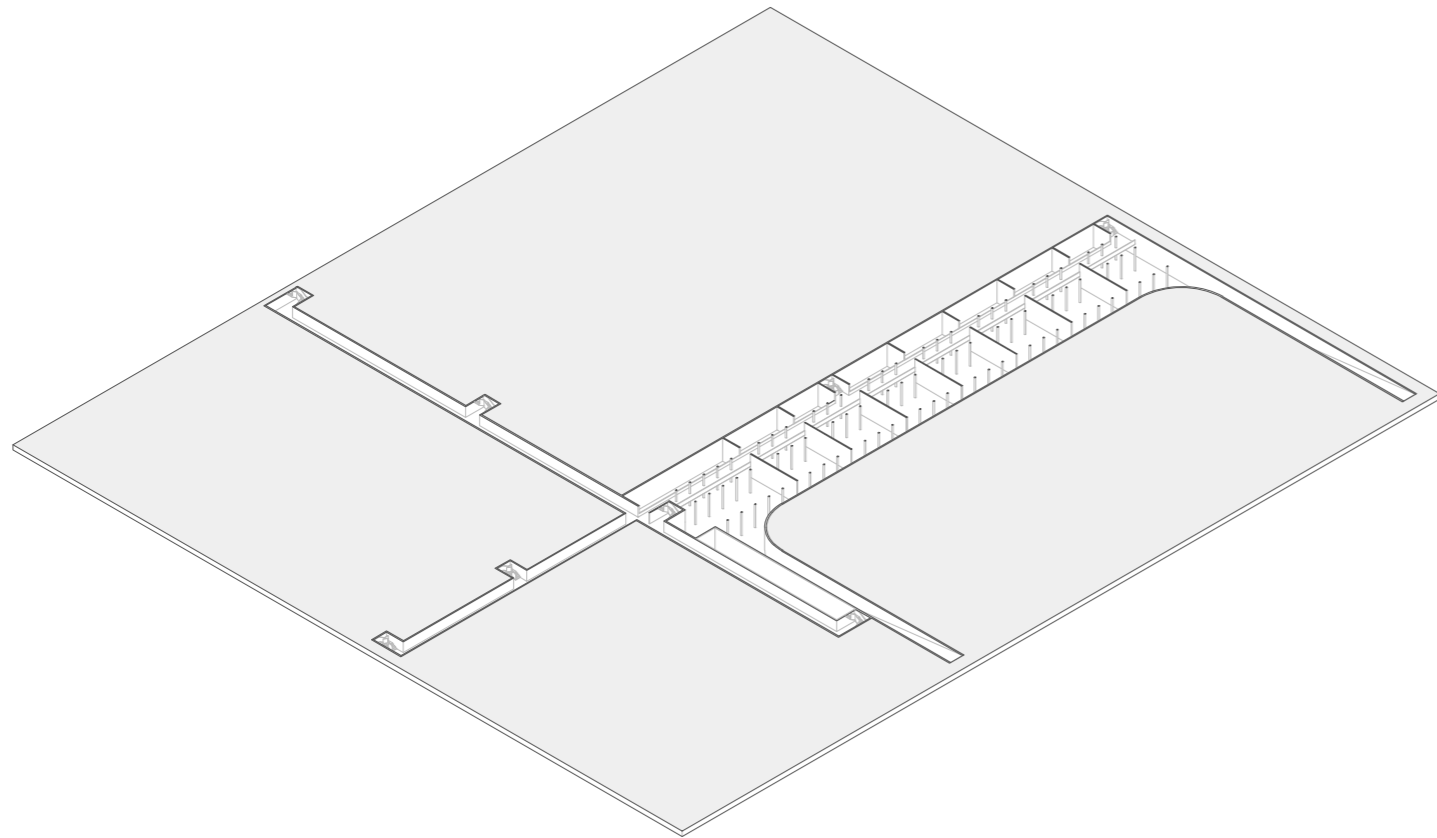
Axonometría seccionada a nivel. Planta baja.
